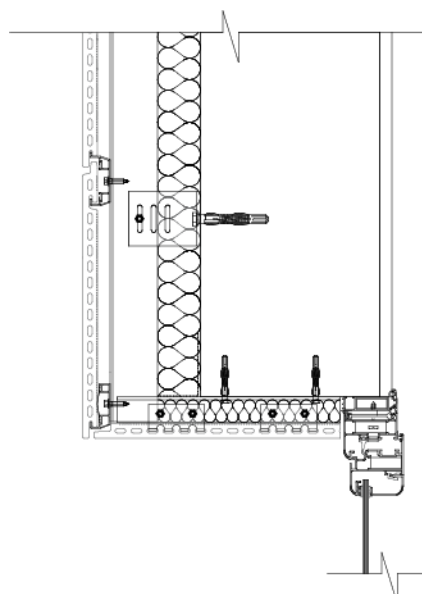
Kit Tempio® FK. Sección vertical.
